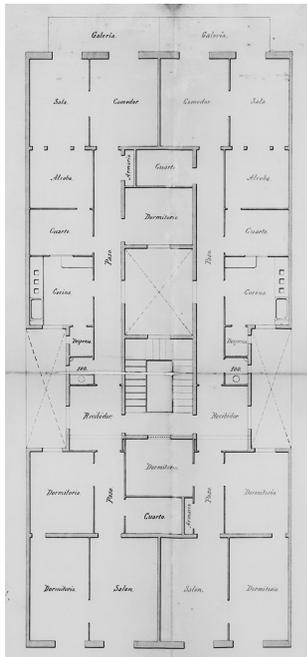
Grundrissplan des ursprünglichen Wohnhauses mit tiefem Grundriss in Jahre 1890.
